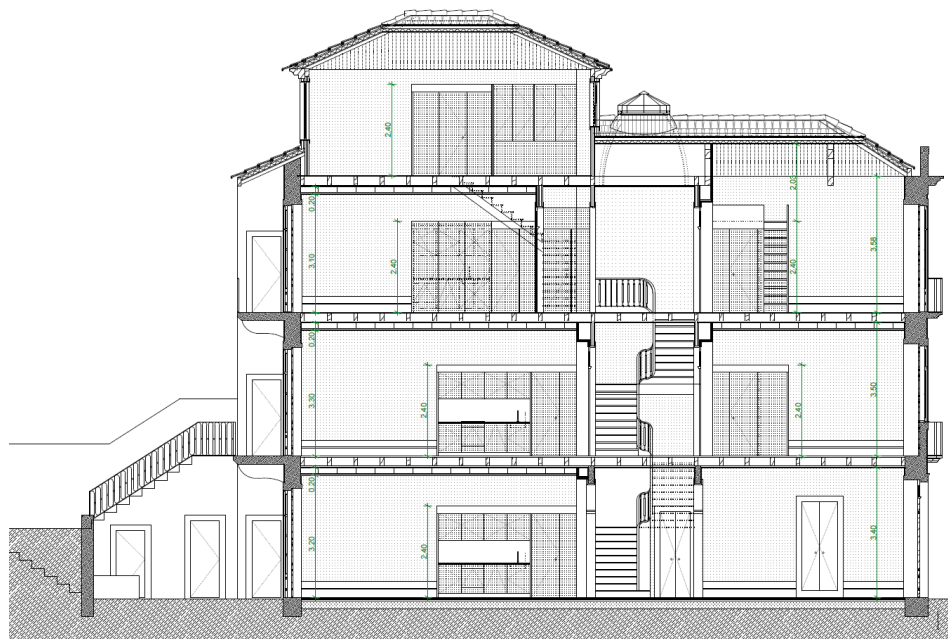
Corte longitudinal CL1, sem escala [Plano Inclinado, Lda., 2014 – Editado pelo autor].
